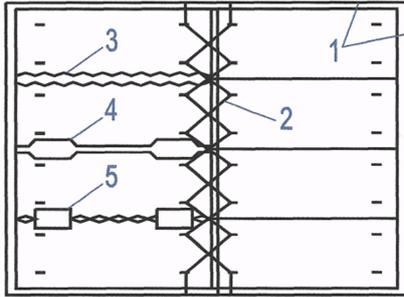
Конструктивные решения по обеспечению жесткости перекрытий и покрытий:
